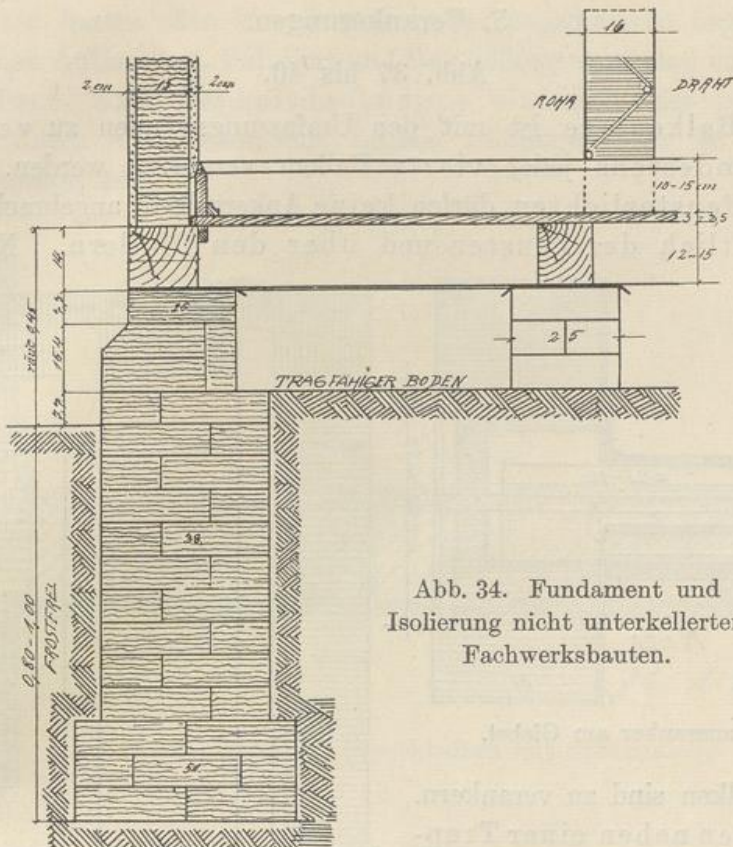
Fundament und Isolierung nicht unterkellerten Fachwerksbauten.
